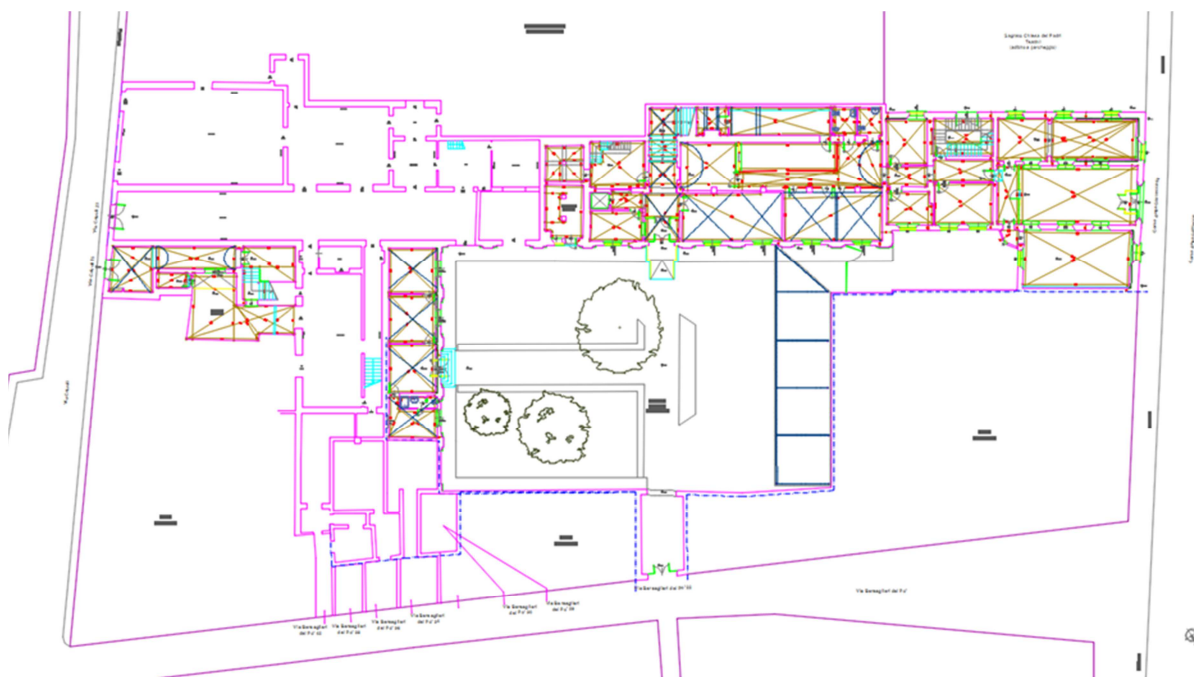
all.4.6 Tav. 09 Pianta Piano Terra locali proprietà private.
